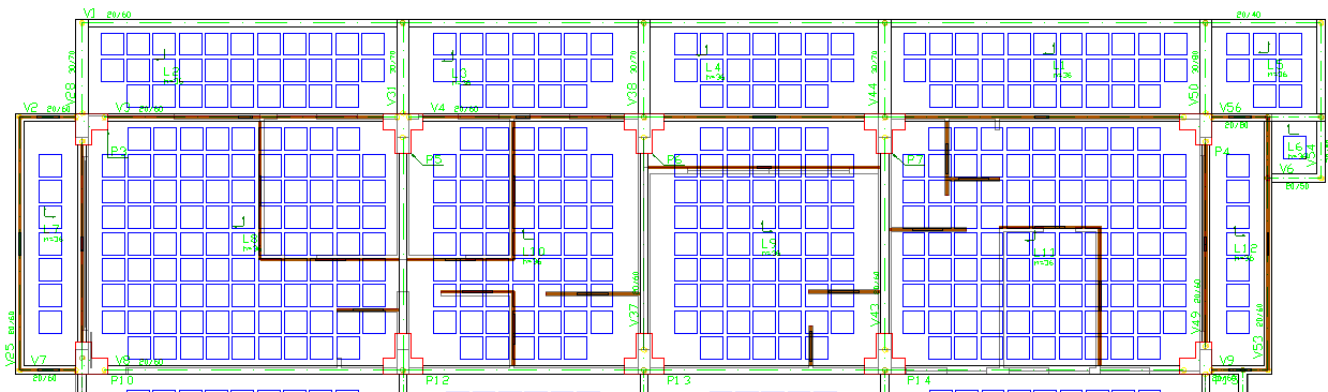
Pavimento PT1, da Solução com Laje Nervurada, com as vigas em balanço de menor comprimento
